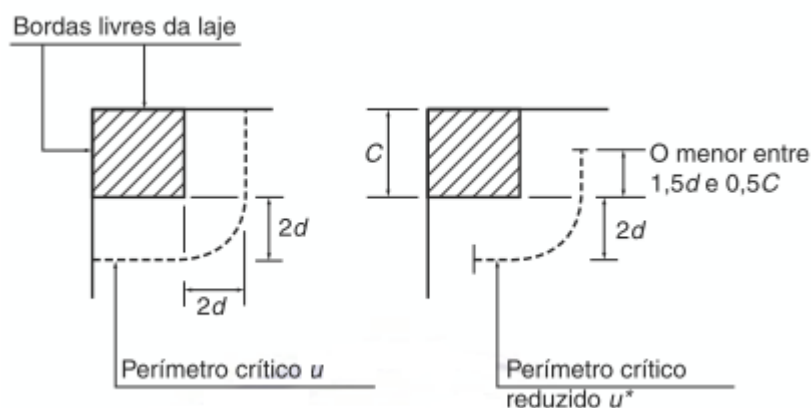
Perímetro crítico em pilares de canto (NBR 6118,2014)
